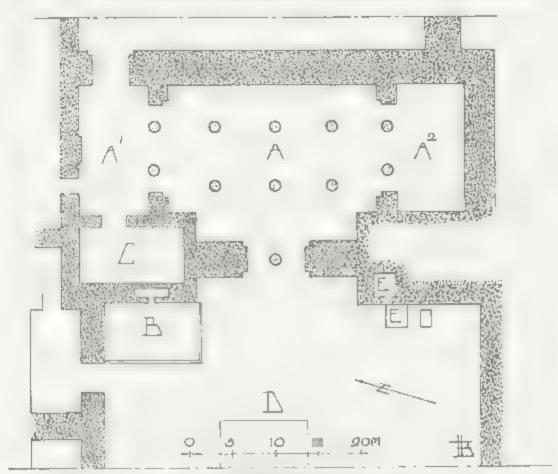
Qatna, Grundriss des Palastheiligtums.
